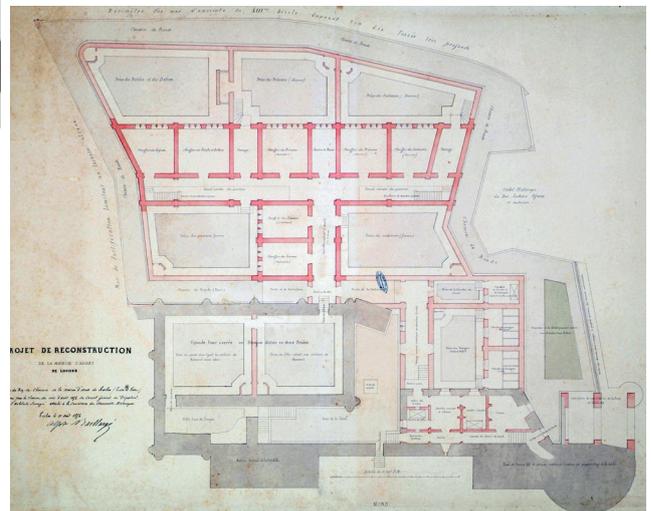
plan du projet de construction de nouvelles prisons de A.-J. Baillargé, 1854 (ADIL IV_31_3_2)
